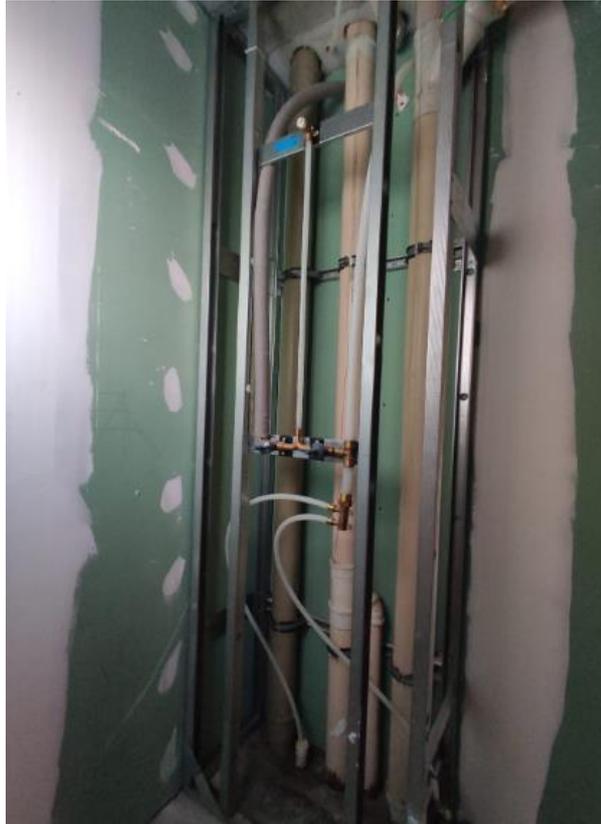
Shaft com chassi de esgoto com estrutura em aço galvanizado leve, pré-fabricada
